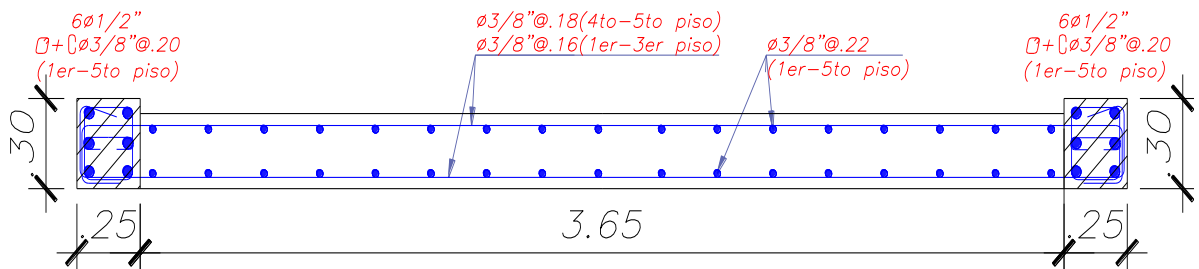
Detalle de Acero de Refuerzo Final en la placa PL-5
